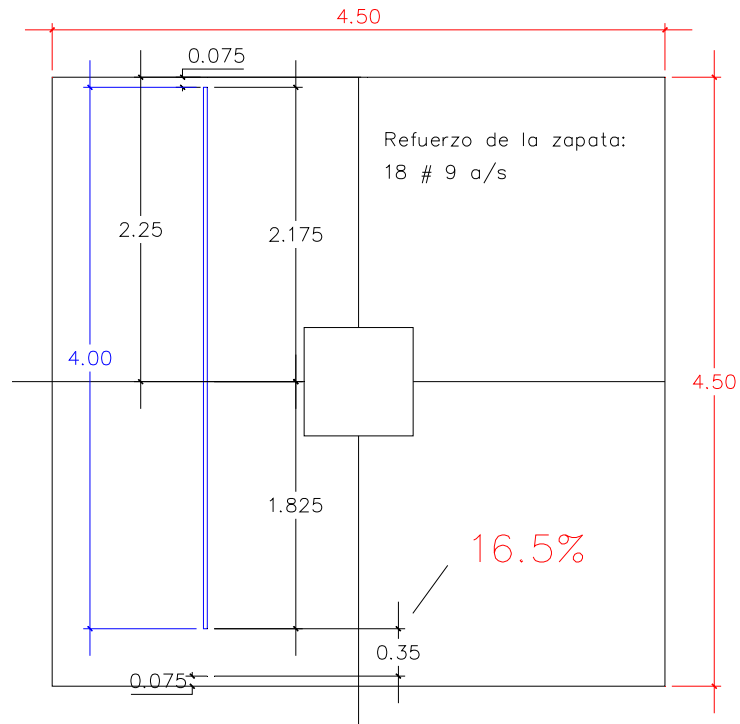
Forma de colocación del refuerzo de la zapata Z-5.
